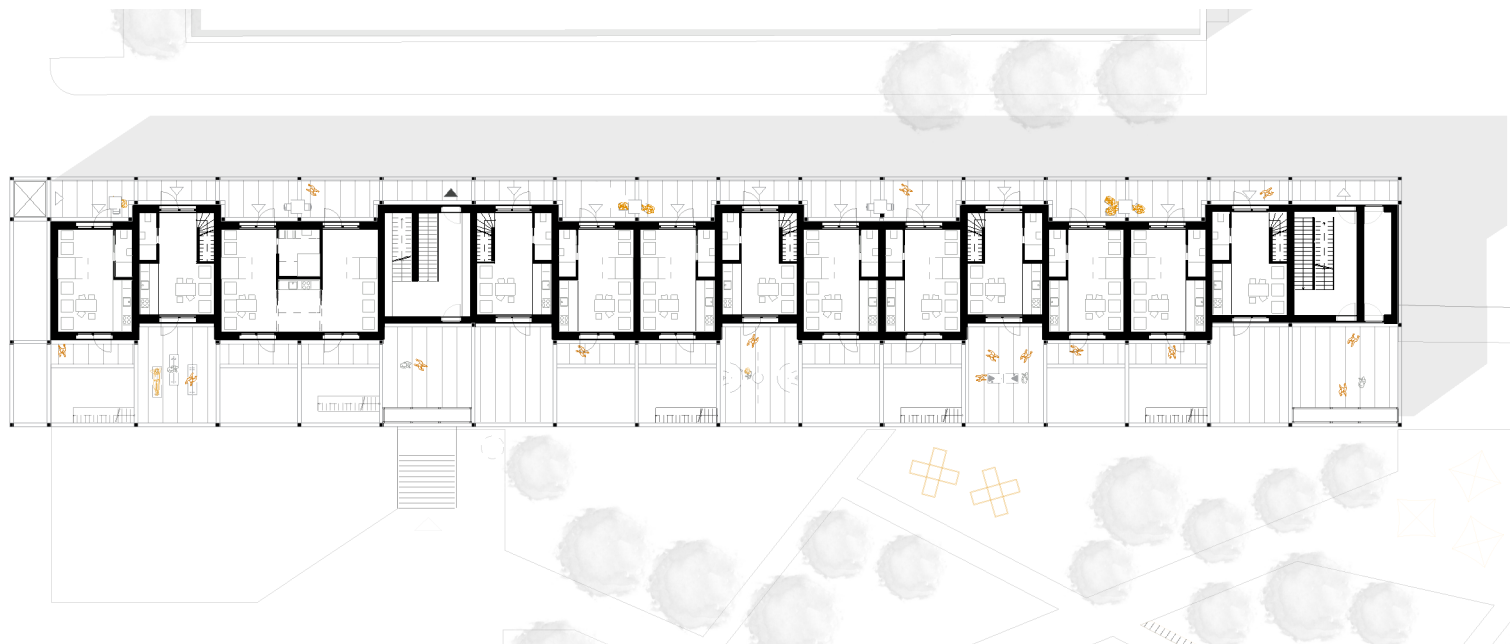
Grundriss 5. Obergeschoss – Aufstockung 1:500
